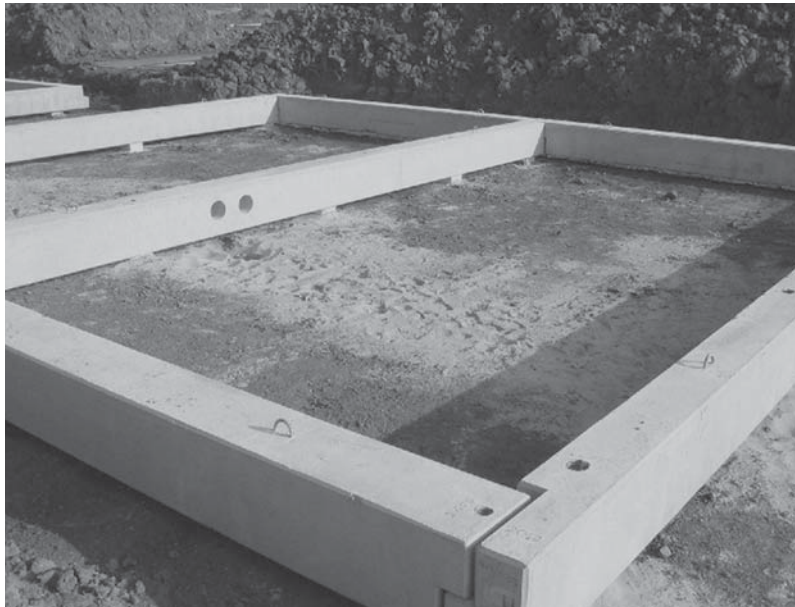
Sfeerimpressie van de eerste fase van Het Mooie Plan
